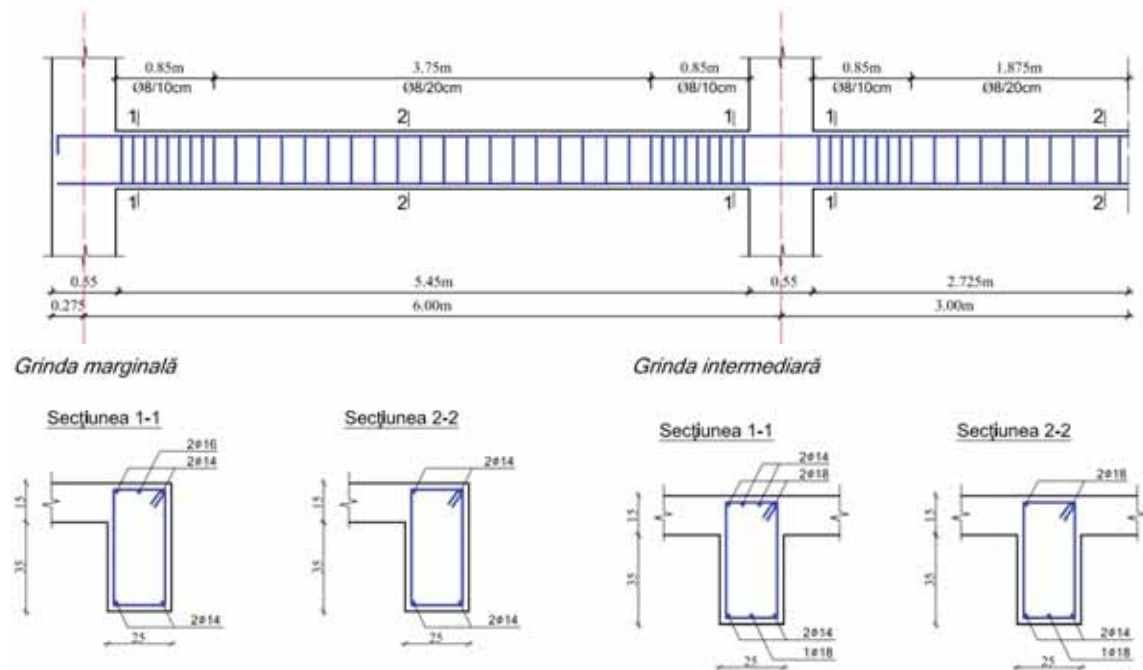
Structură P+5E: plan armare grindă longitudinală/transversală b.a.
